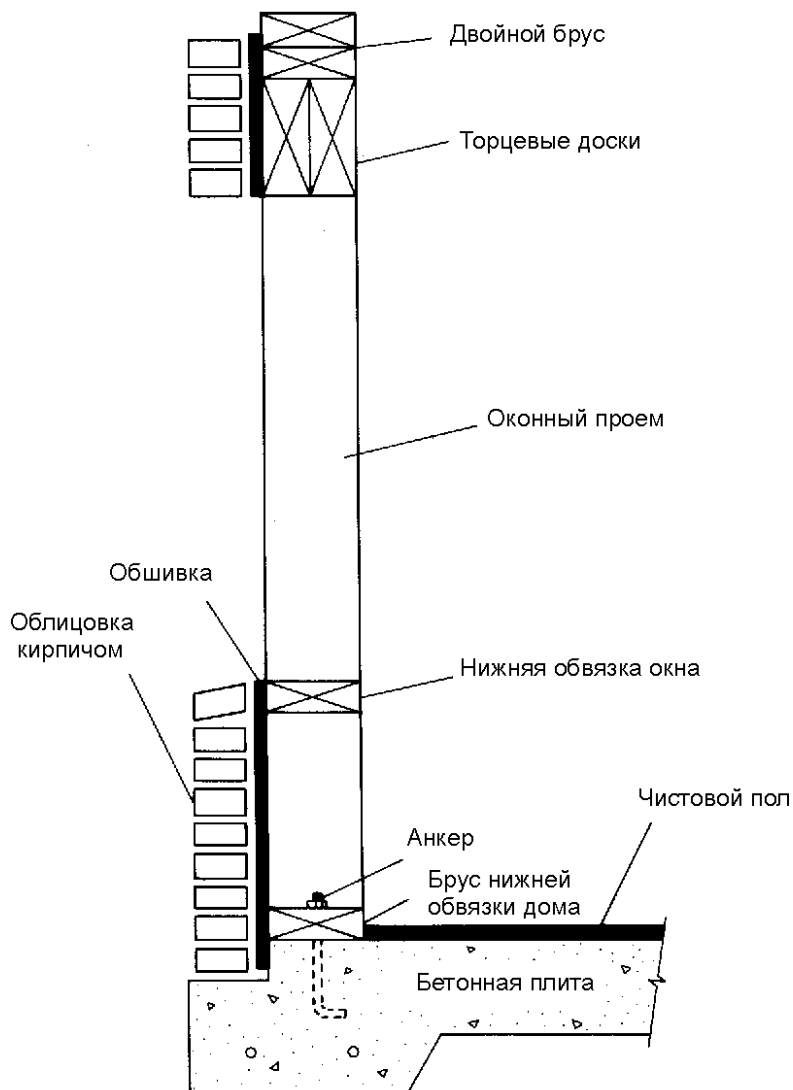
Вид в разрезе стены, установленной на бетонную плиту
